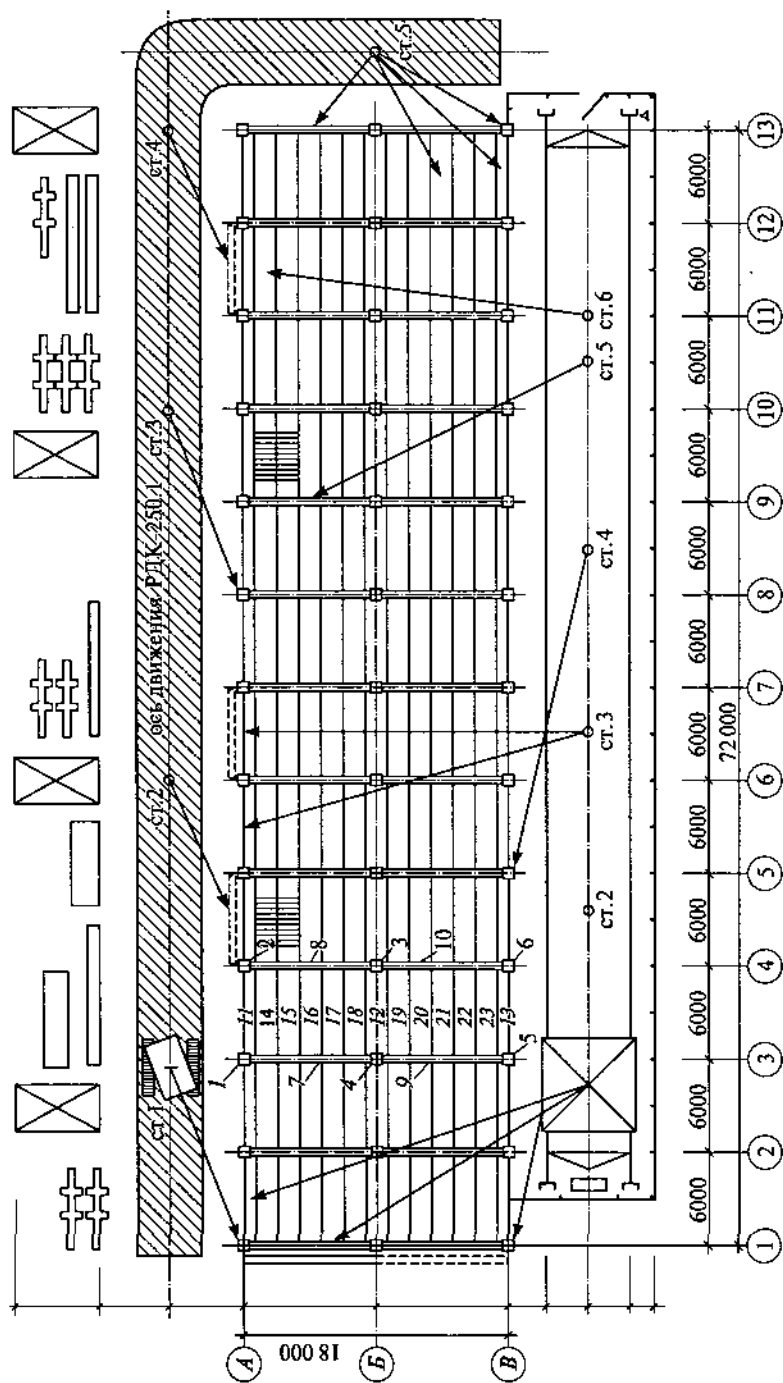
Фрагмент строительного плана на период монтажа надземных конструкций многоэтажного каркасного здания:
